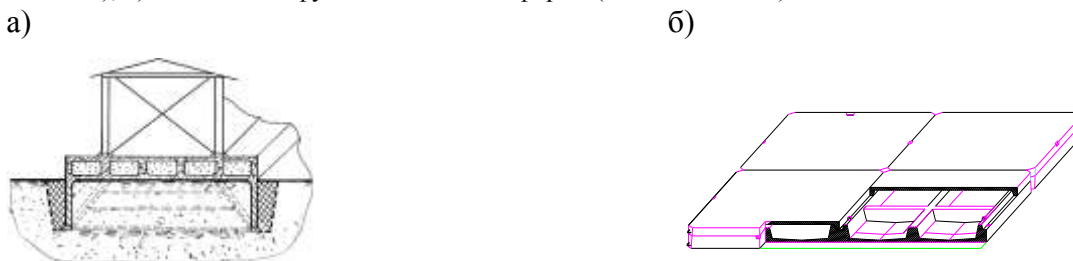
а) ПФП со «стенами в грунте» под здания и сооружения для строительства на слабых грунтах и в сейсмических зонах (патент РФ № 64650); б) пространственная железобетонная фундаментная платформа в сборном и сборно-монолитном вариантах под малоэтажное строительство в сложных грунтовых условиях (патент РФ № 69094)
